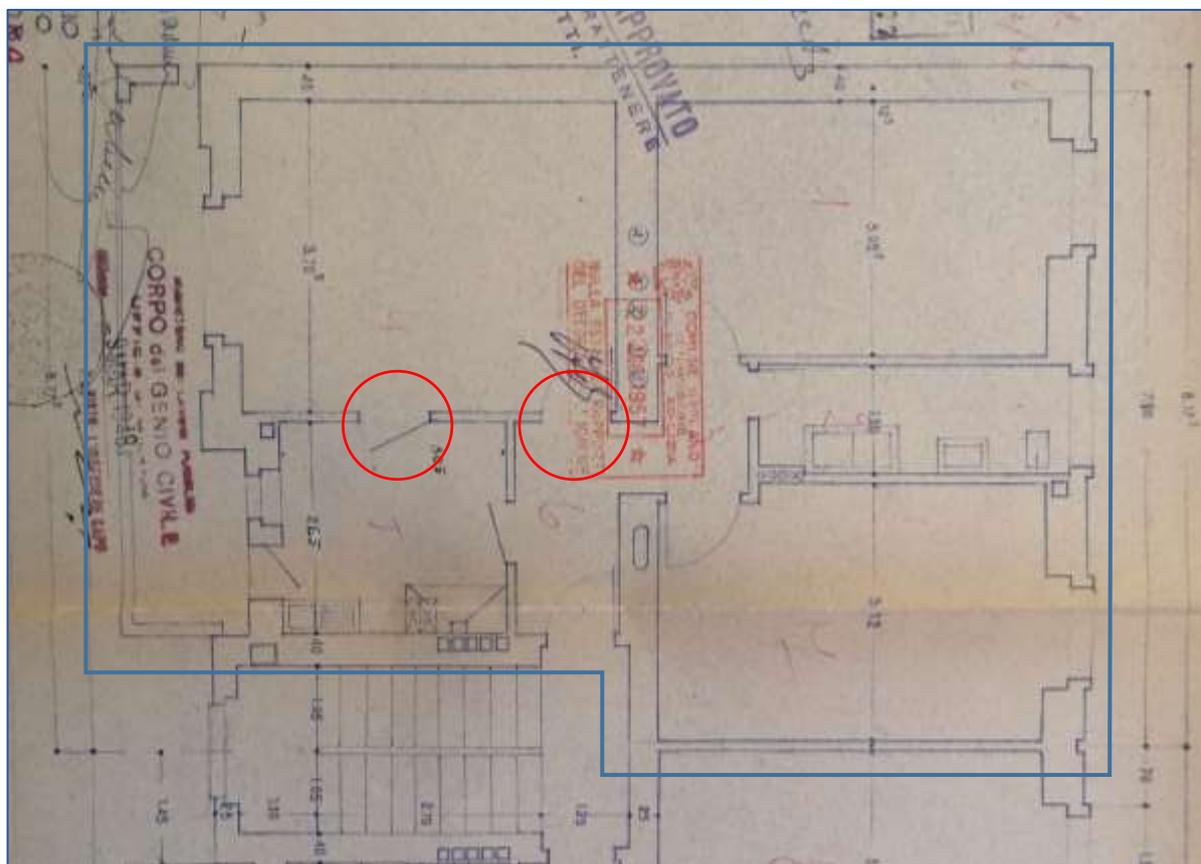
Estratto della planimetria di progetto con individuazione delle difformità
